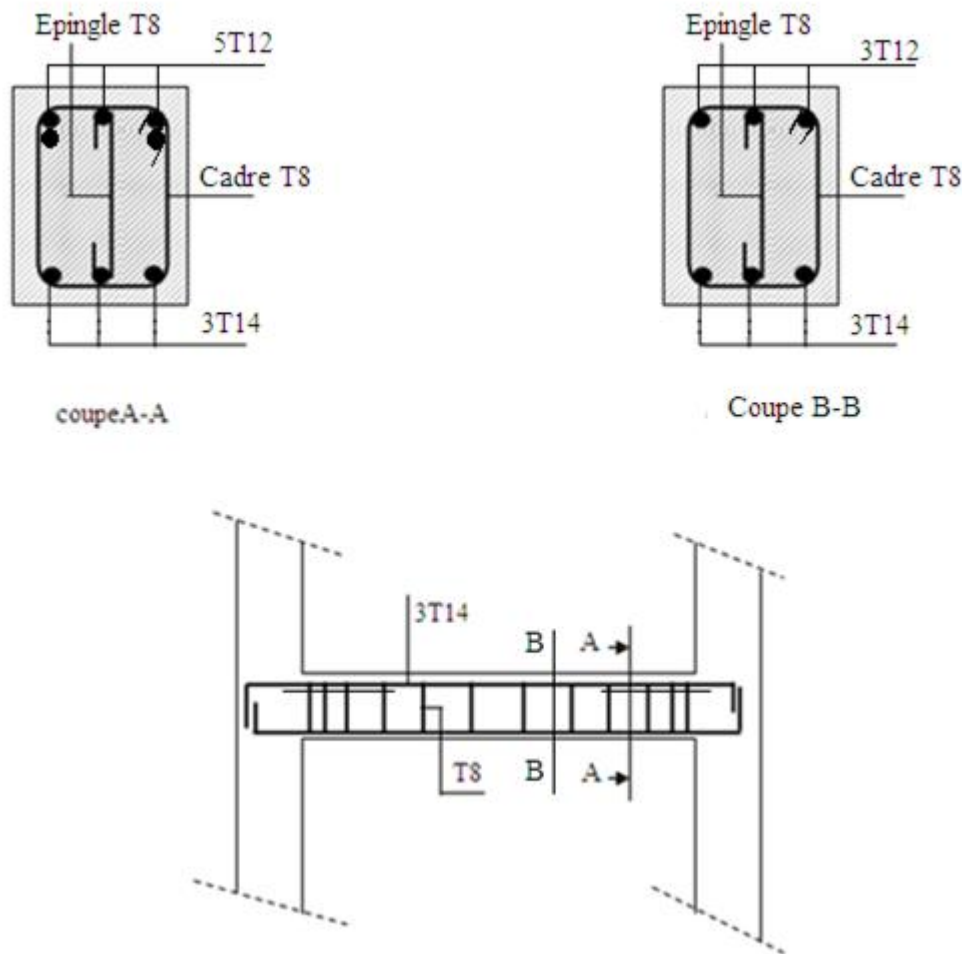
Schéma de ferrailage de la poutre palière.
